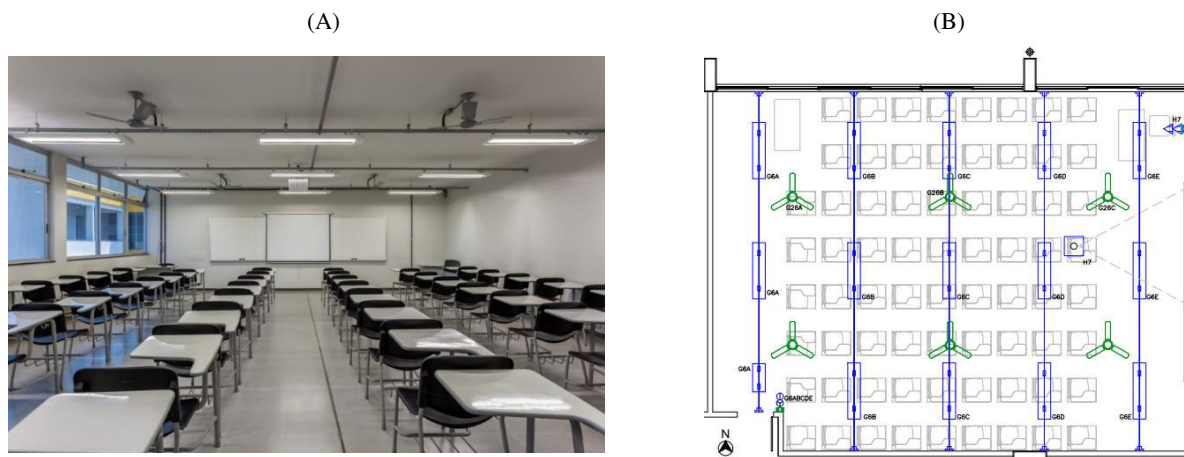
Interior de sala de aula tipo do CAD 3 (A) Foto (B) Planta-baixa do projeto luminotécnico e elétrico da Sala 403 (ARCHDAILY, 2020; DPP-UFMG, 2021).
